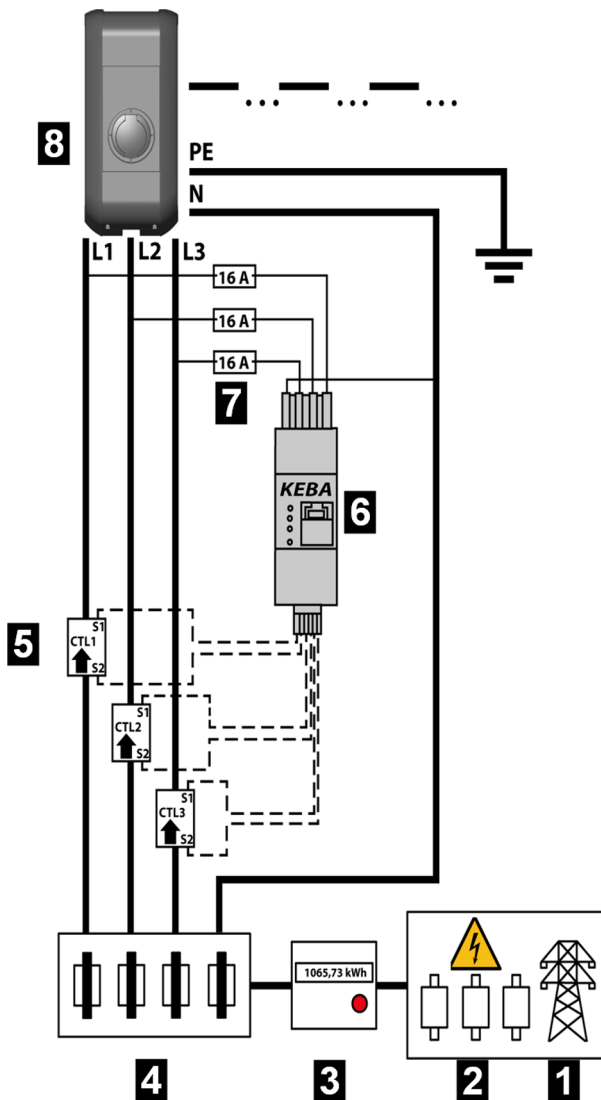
Vue d'ensemble des connexions Courant triphasé
